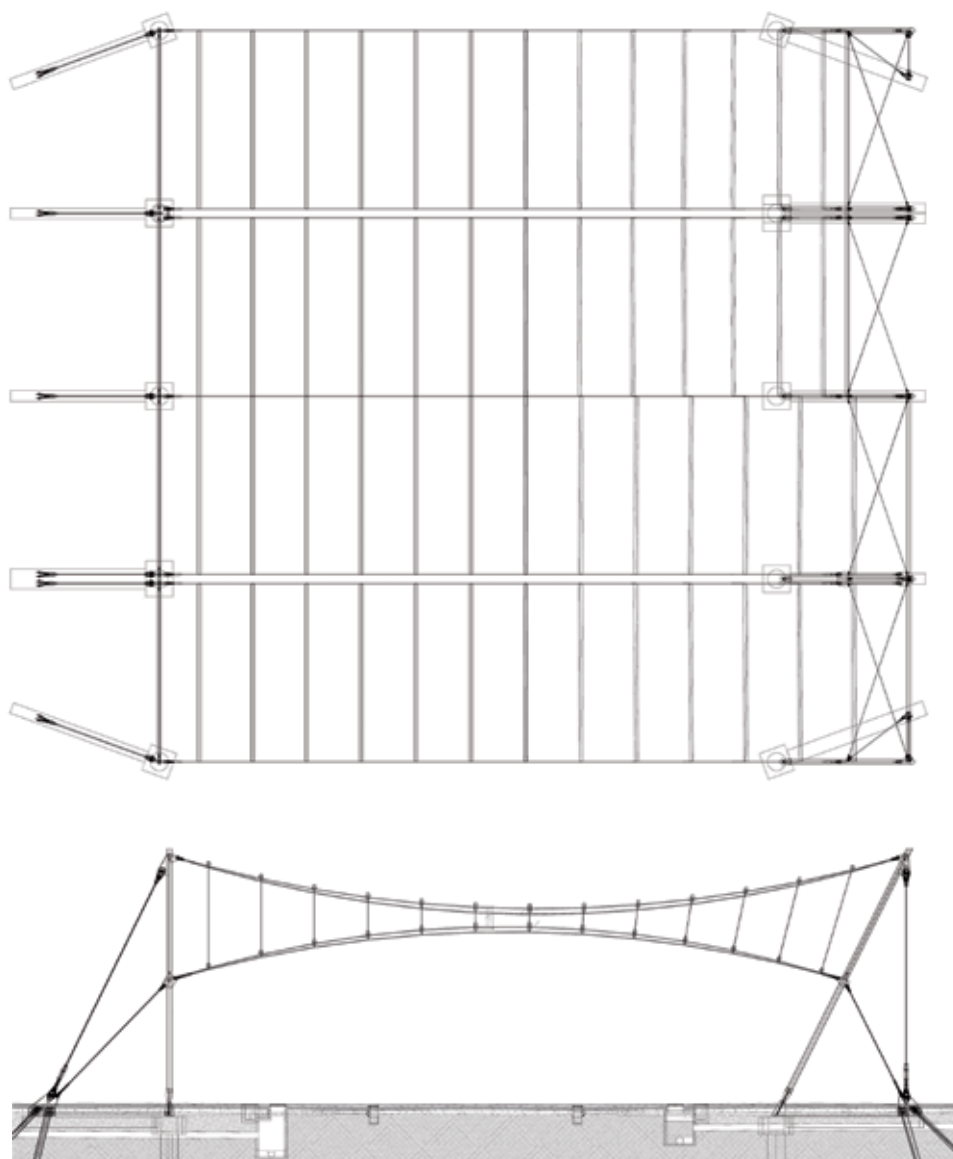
Pianta e sezione del modulo tipico del Decumano
